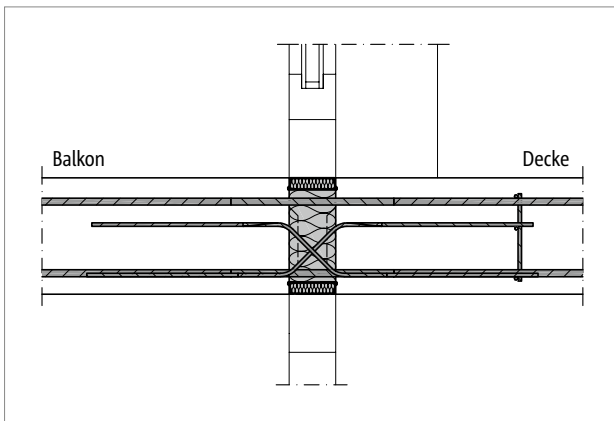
Schöck Isokorb® T Typ DP: Einbausschnitt; einachsig gespannte Decke
